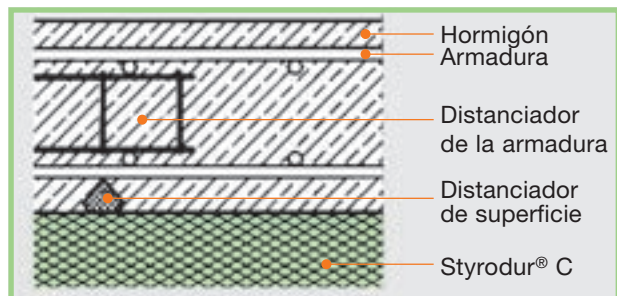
Distanciador de la losa de hormigón de fibra para el refuerzo inferior y cesta de sustentación de la armadura para el refuerzo superior de la losa del suelo.
